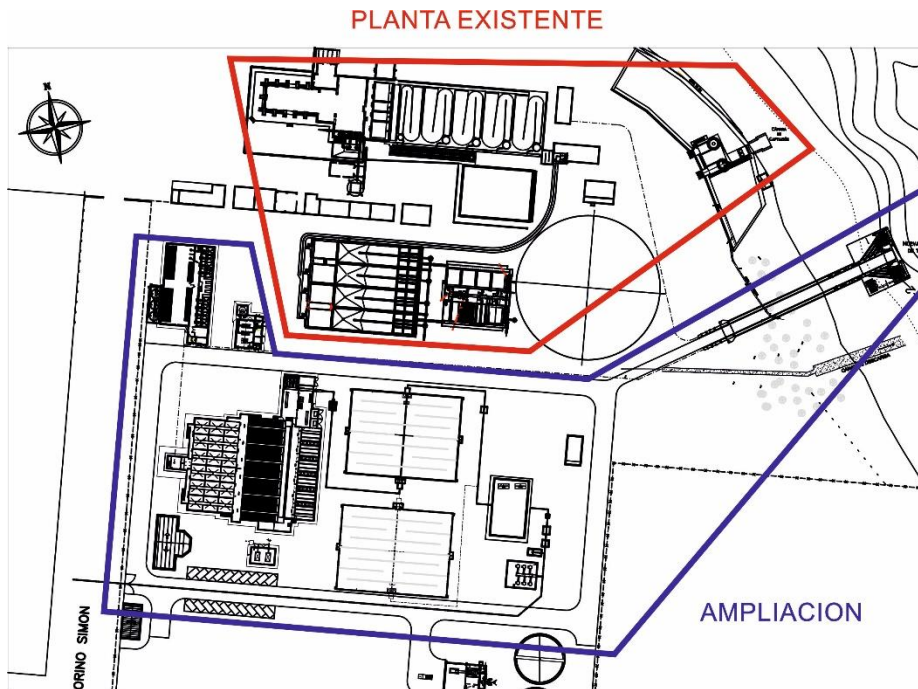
Lay Out de la planta existente y de la proyección de la ampliación.
